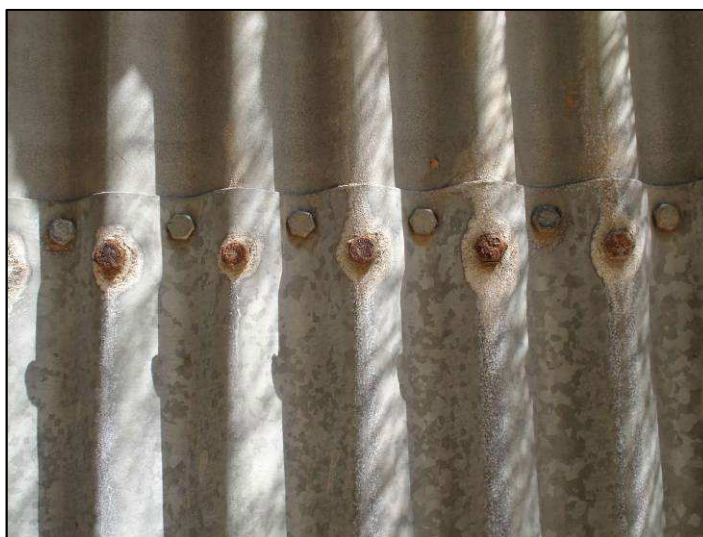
Anclajes oxidados en un tubo metálico.
